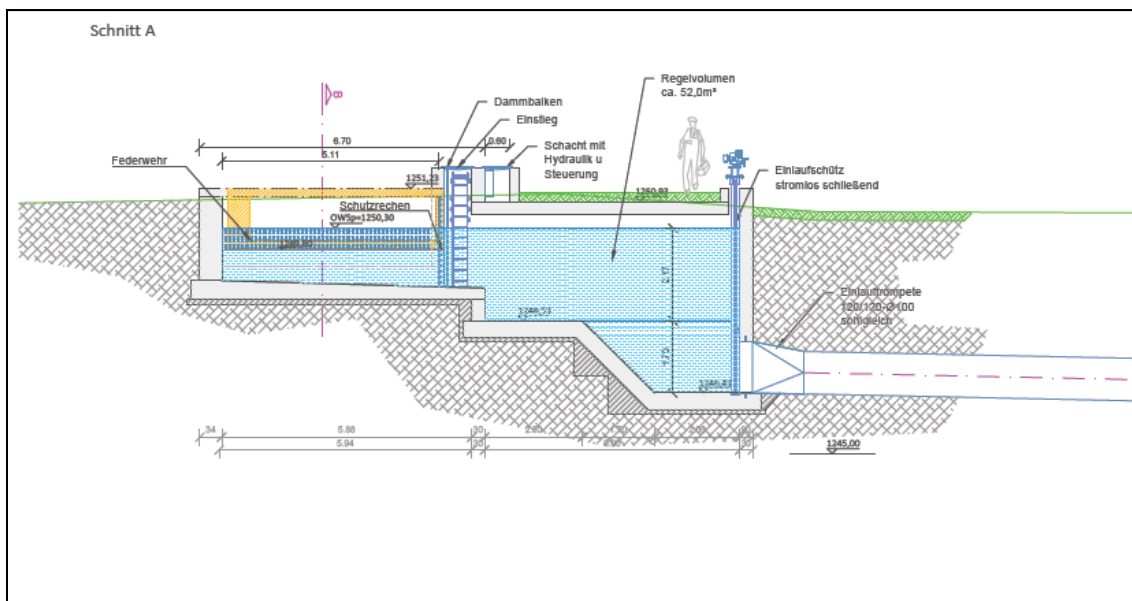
Prospetto opera di presa (fonte: Tavole progettuali)
